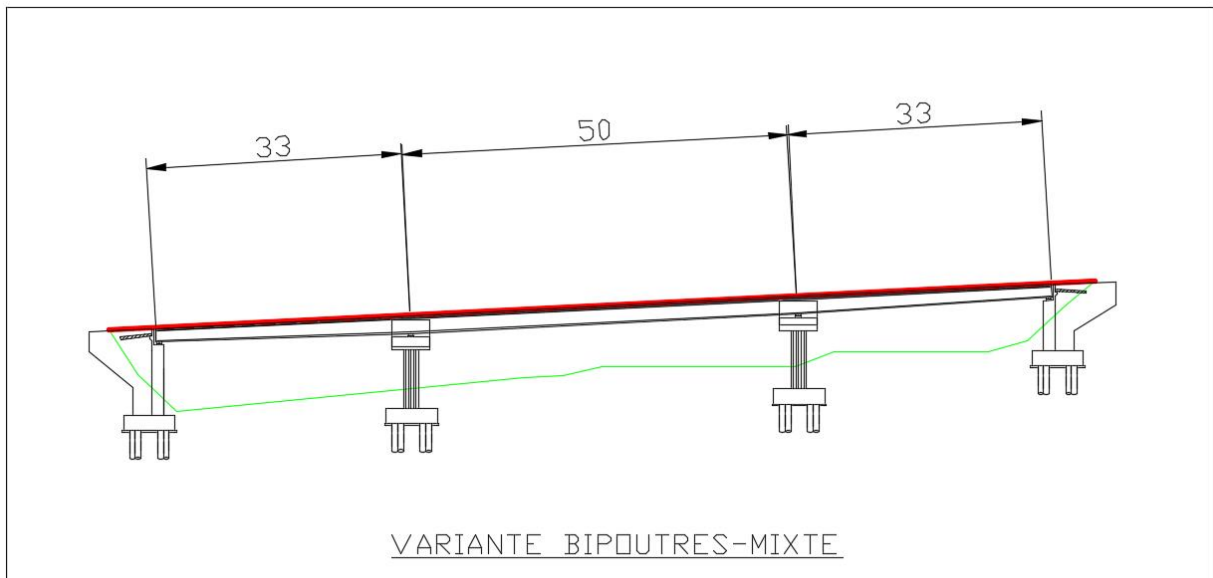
Profil en long de la variante Bipoutre mixte (AutoCAD 2016).
